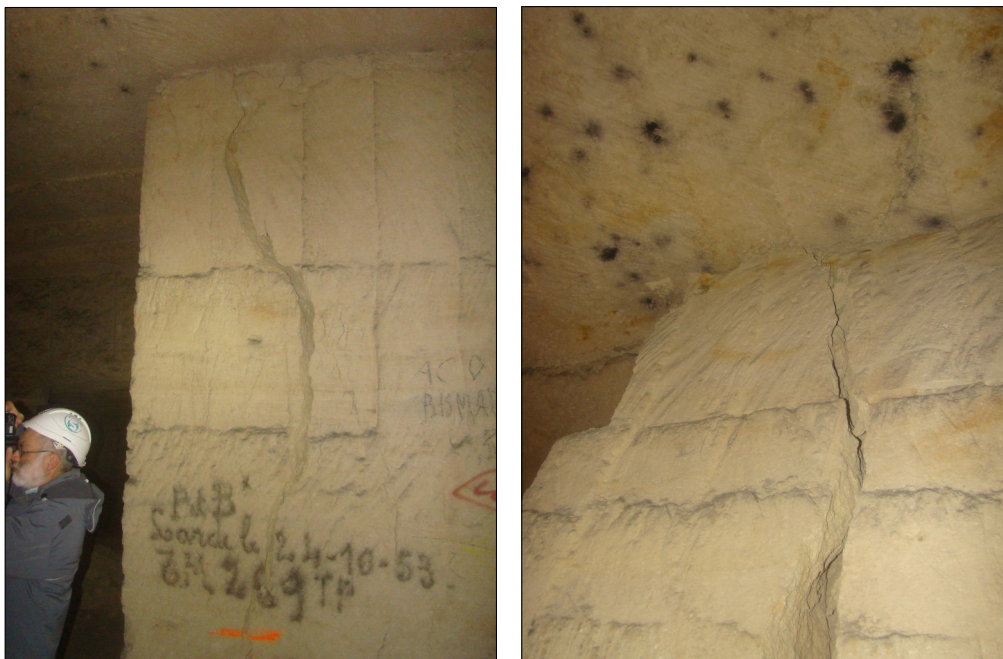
Fissuration d'angles de piliers dans la carrière du Château (Niveau -3) [Source : Ginger CEBTP]
